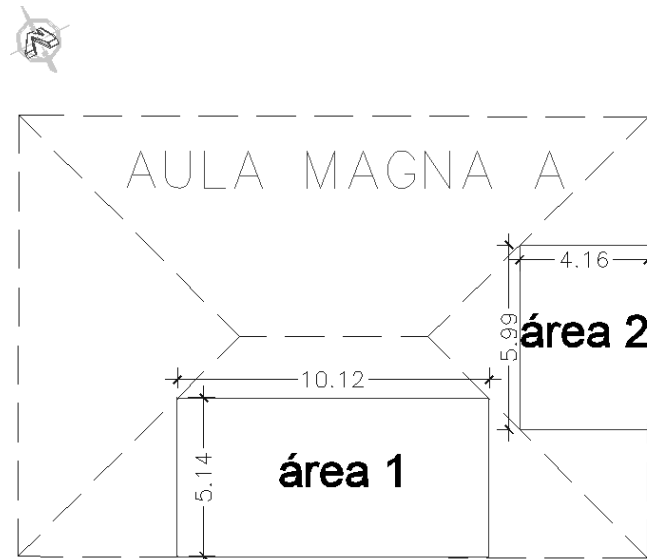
Vista en planta del aula magna A y el área a considerar.
